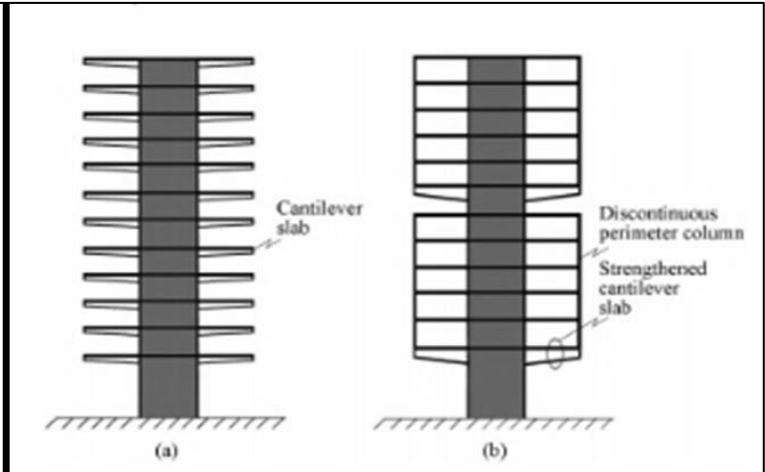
Coupe analytique d'un édifice en noyau central est des dalles en porte-à-faux
